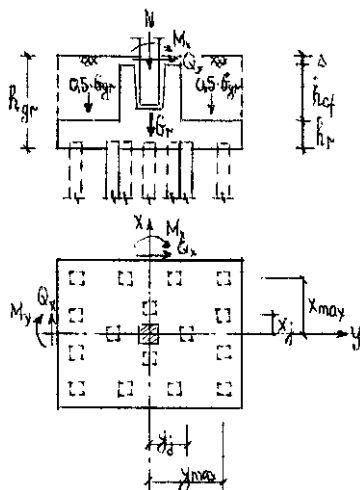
Схема к определению усилий в сваях внецентренно нагруженного фундамента
